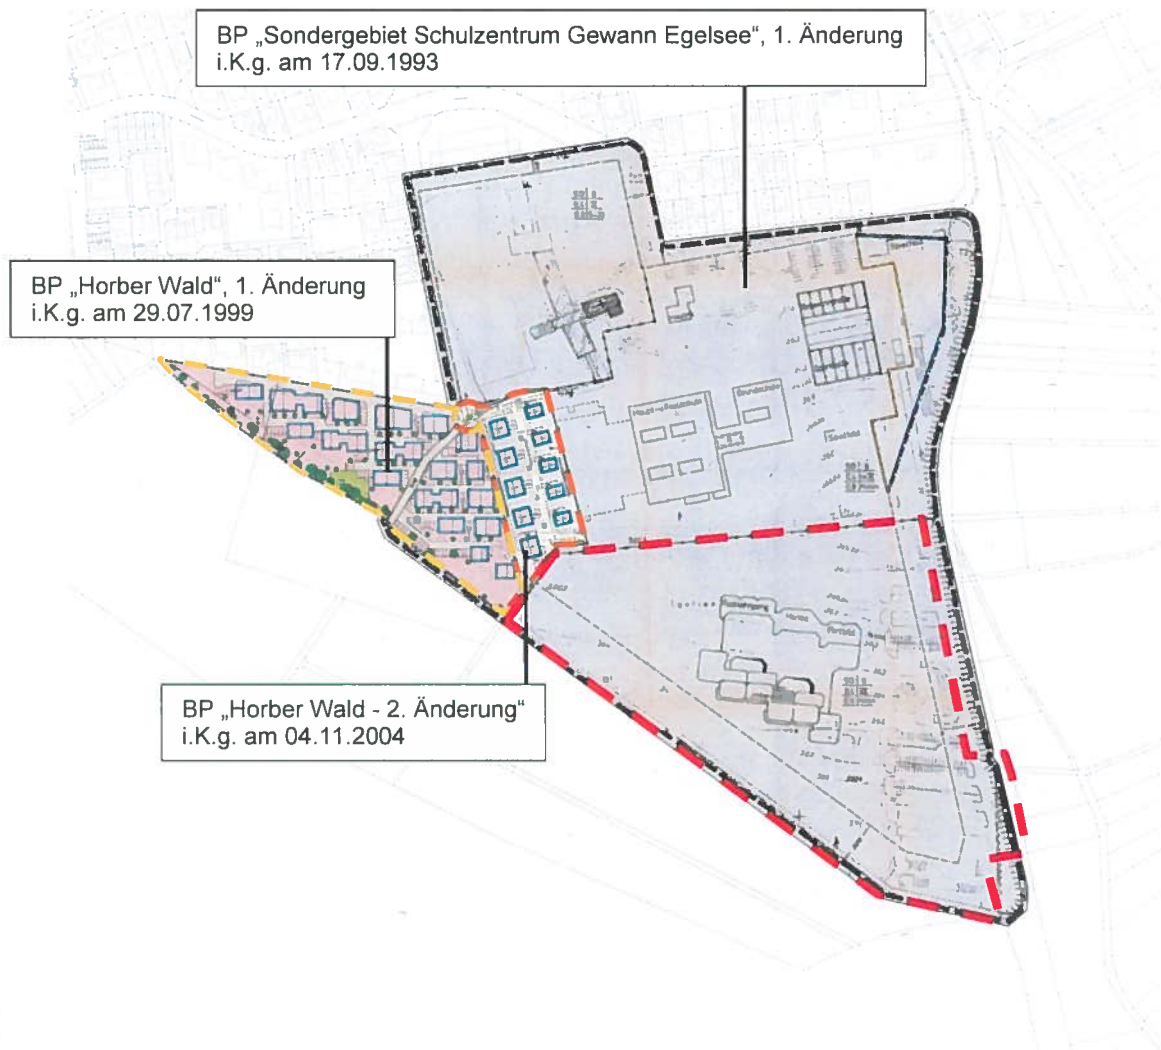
Bebauungsplan „Akademiegärten“ (in rot) mit angrenzenden Bebauungsplänen
